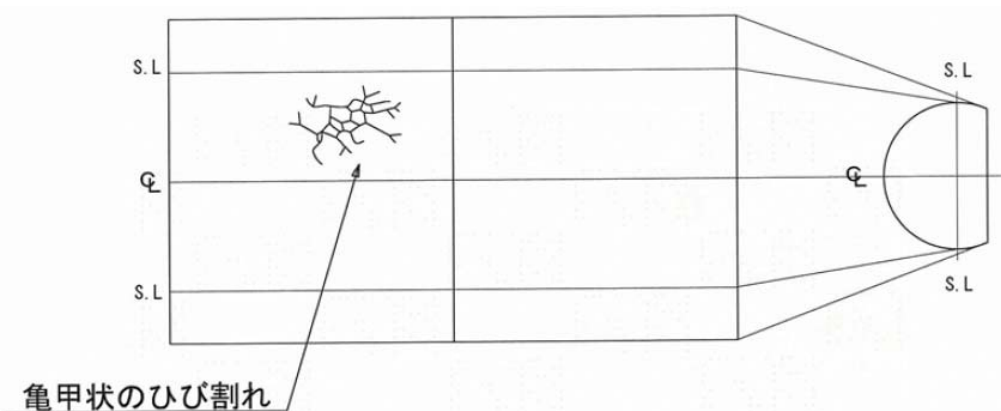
7 覆工コンクリートの亀甲状のひび割れによる細片化の例
